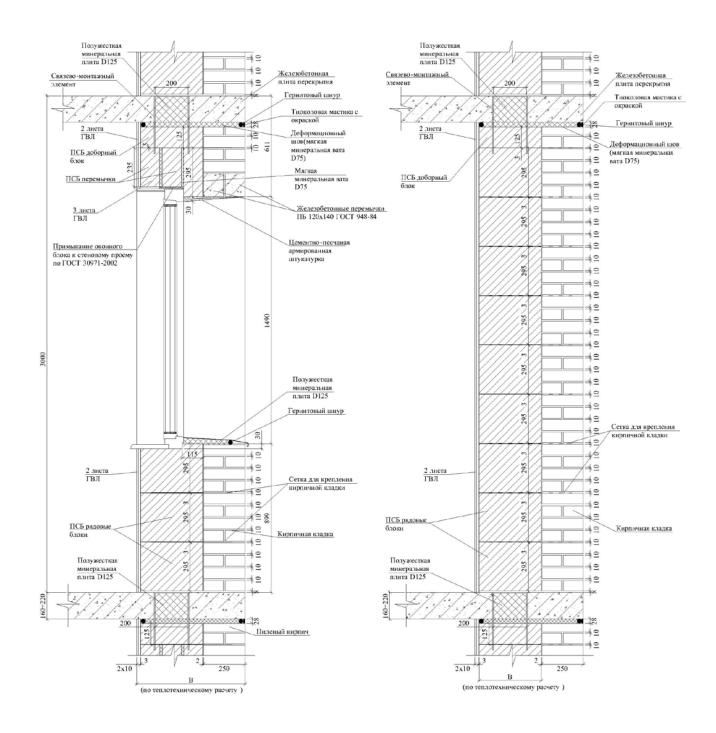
Ненесущая стена из ПСБ блоков с наружной кирпичной облицовкой толщиной в 1 кирпич и внутренней облицовкой ГВЛ. Вертикальные разрезы по оконному проему и глухому простенку
